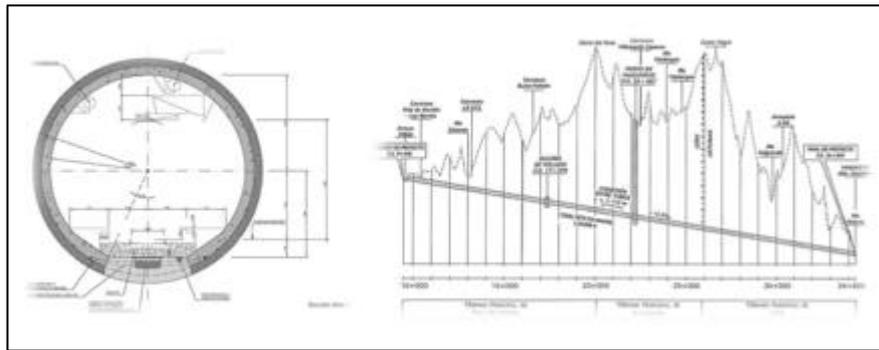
Ejemplo plano sección tipo y perfil longitudinal (túnel de Pajares). Fuente: autodesk.com.
